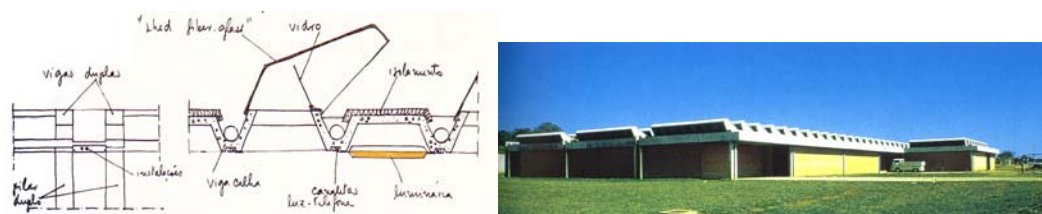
e 1.6. Sheds e Fachada da Revendedora Planalto, Brasília.
